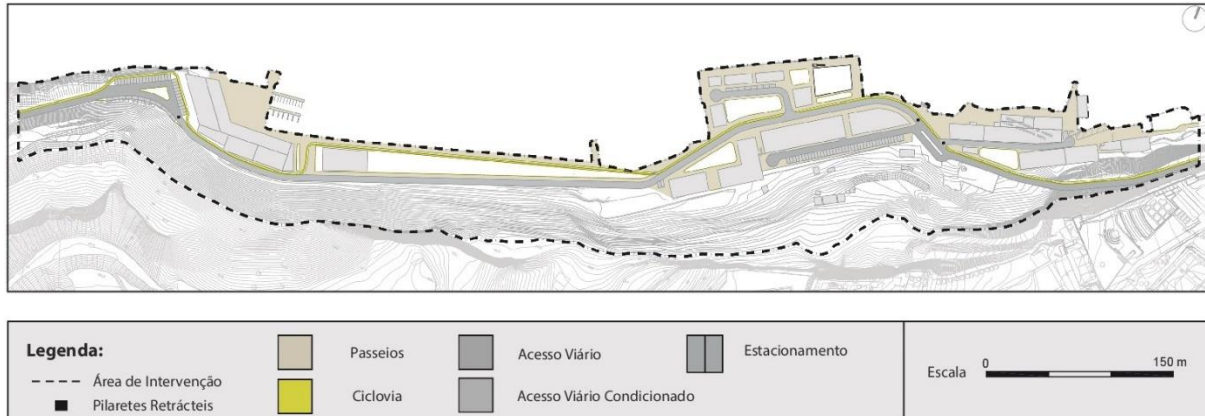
Planta de Acessibilidades e Estacionamento
